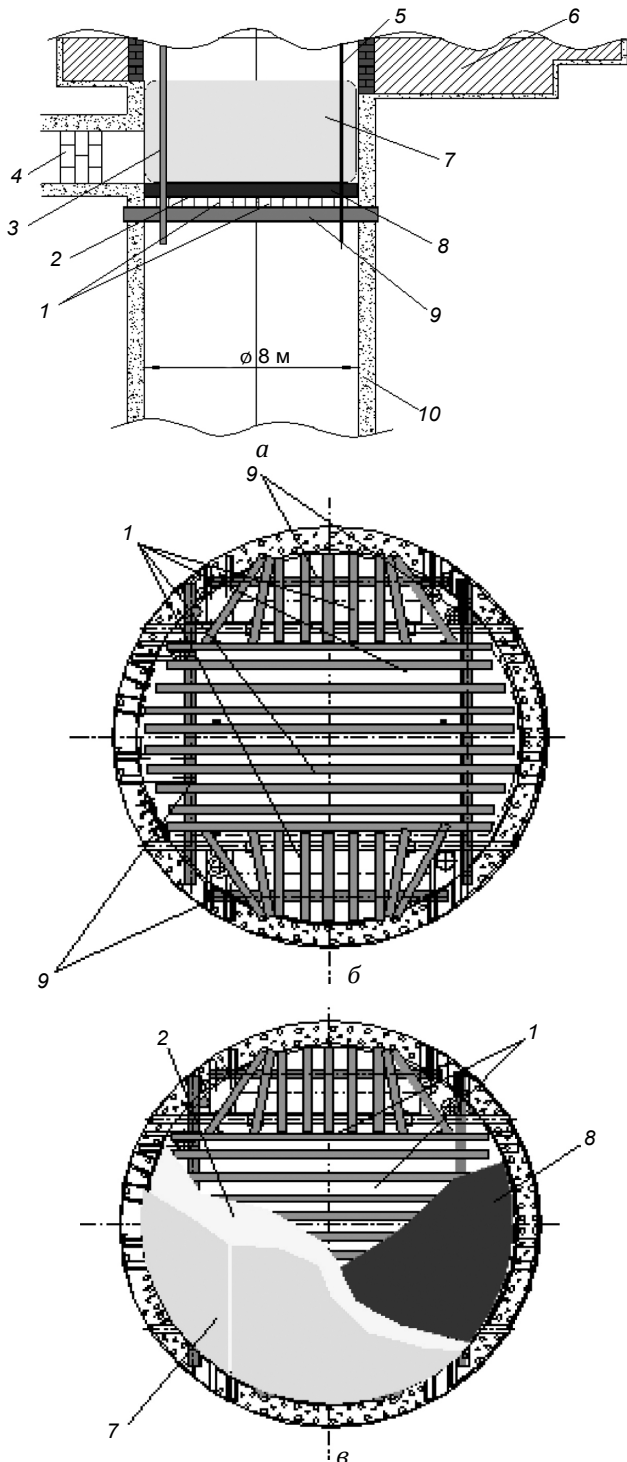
Схема изоляционной перемычки ВПС №1: *а* – продольный разрез; *б* и *в* – поперечные разрезы: 1 – промежуточные металлические балки; 2 – металлический лист; 3 – дренажный трубопровод; 4 – бетонитовая перемычка; 5 – линия «Дистоп»; 6 – устье ствола [3]; 7 – эластичные емкости; 8 – гипсовый слой; 9 – опорные металлические балки; 10 – монолитная бетонная крепь ствола.
